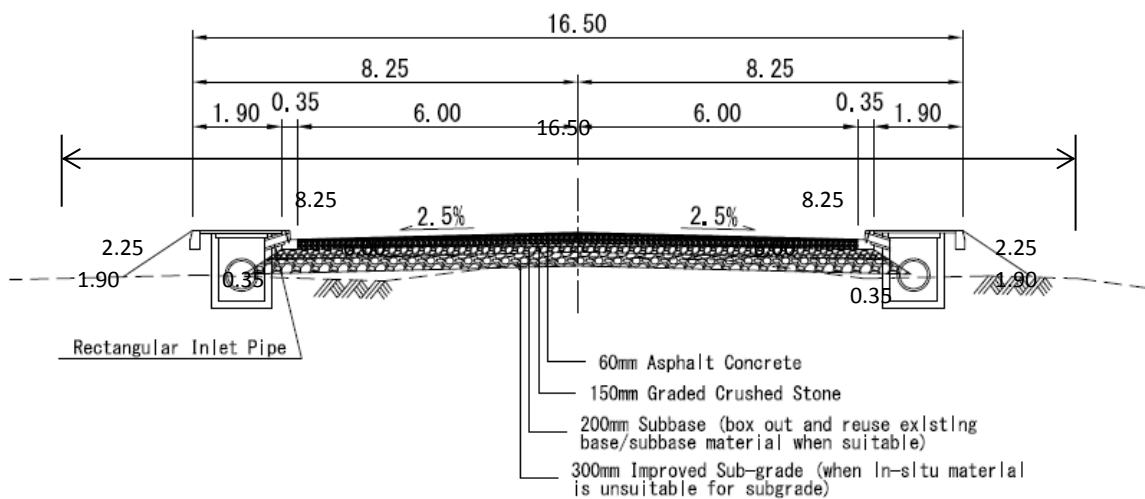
道路標準断面図 (計画) Road Q、Road F-1b/1c (橋梁 No.4、No.7)
